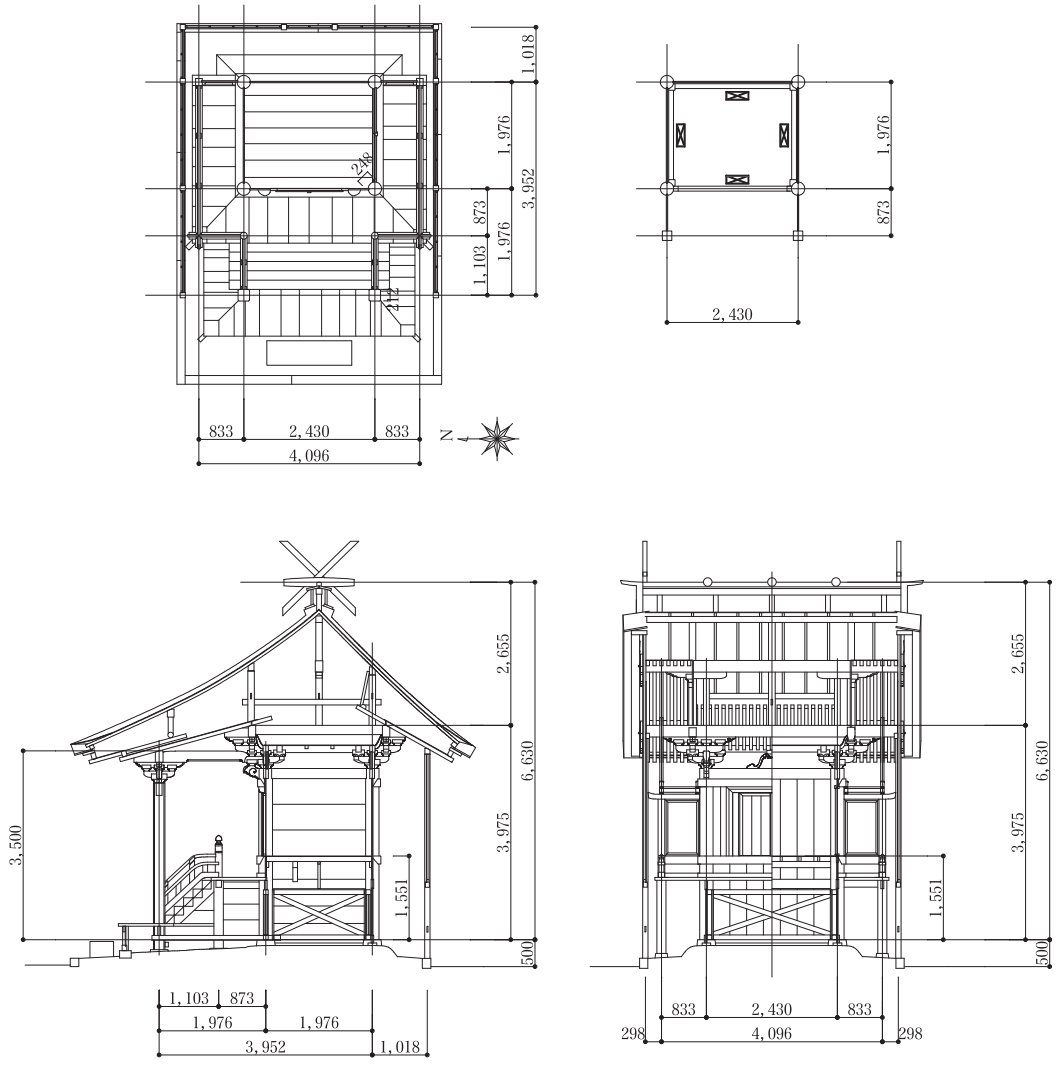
甲良神社本殿 平面図、補強配置図、梁間断面図、桁行断面図
